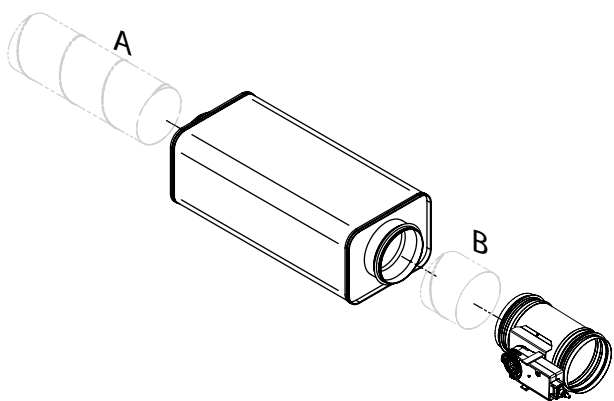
Kit de soufflage, PARAGON T-SAK-VAV-125
